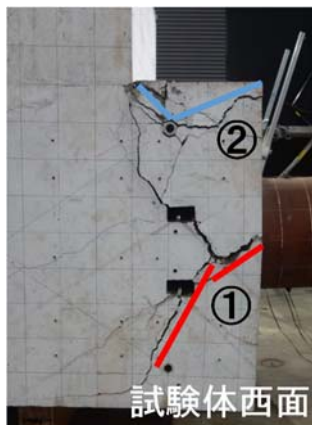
試験体 No. 1 のひび割れ幅を計測した代表ひび割れ (写真は最終破壊状況)
